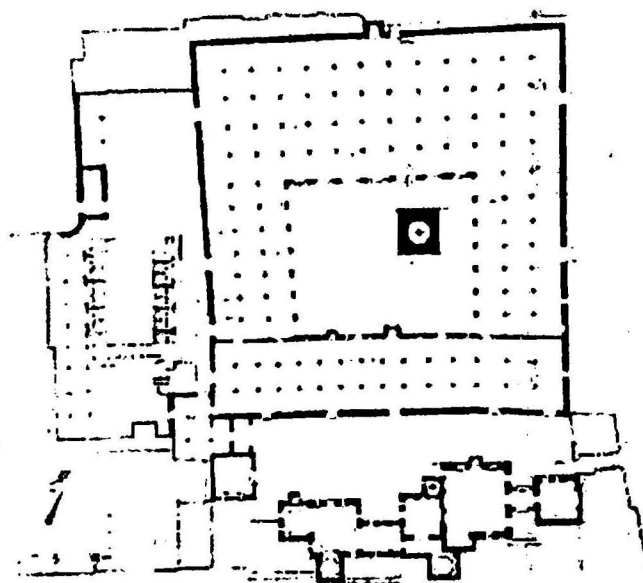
ب- مسقط أفقي للجامع الكبير بمدينة
